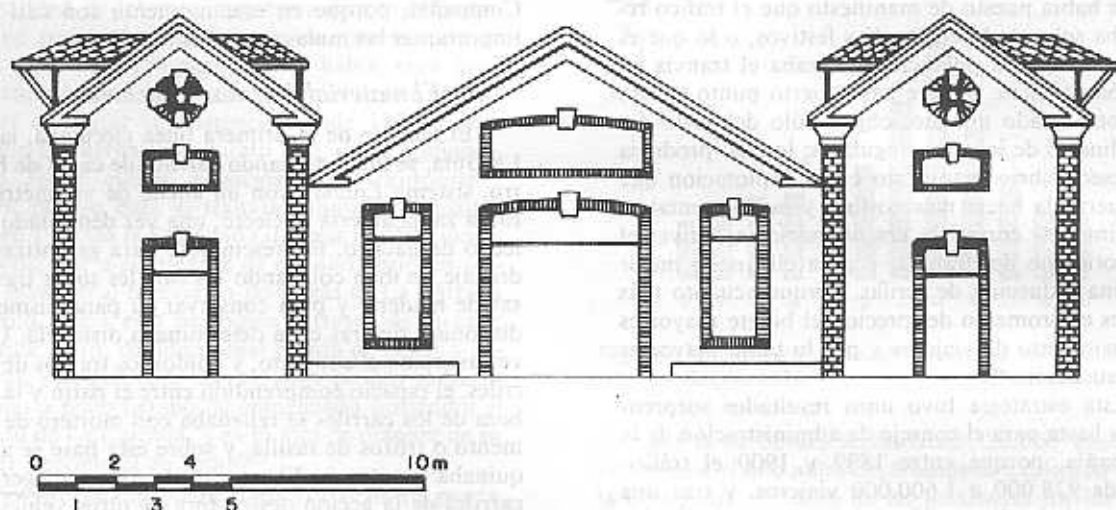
Alzado de las primeras cocheras de los tranvías de Gijón, construidas en 1890.
